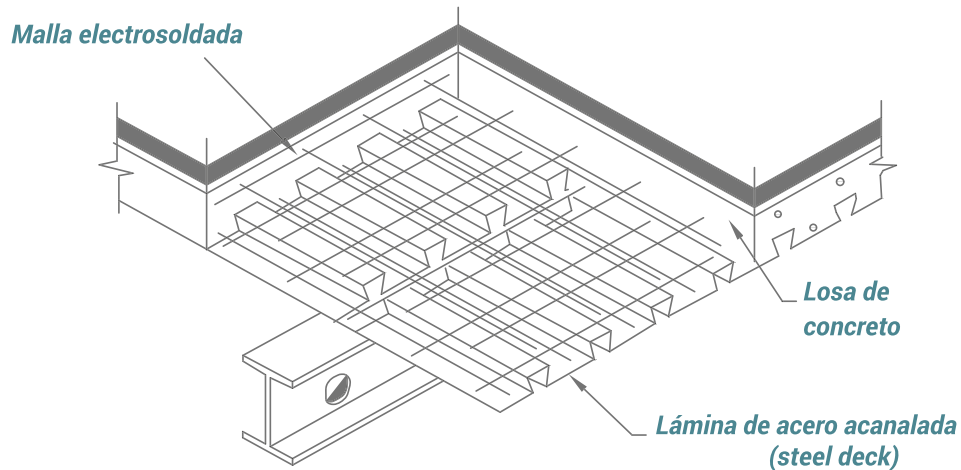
Sistema de piso compuesto acero-concreto típico en edificios convencionales (losa colada sobre un sistema de lámina acanalada).
